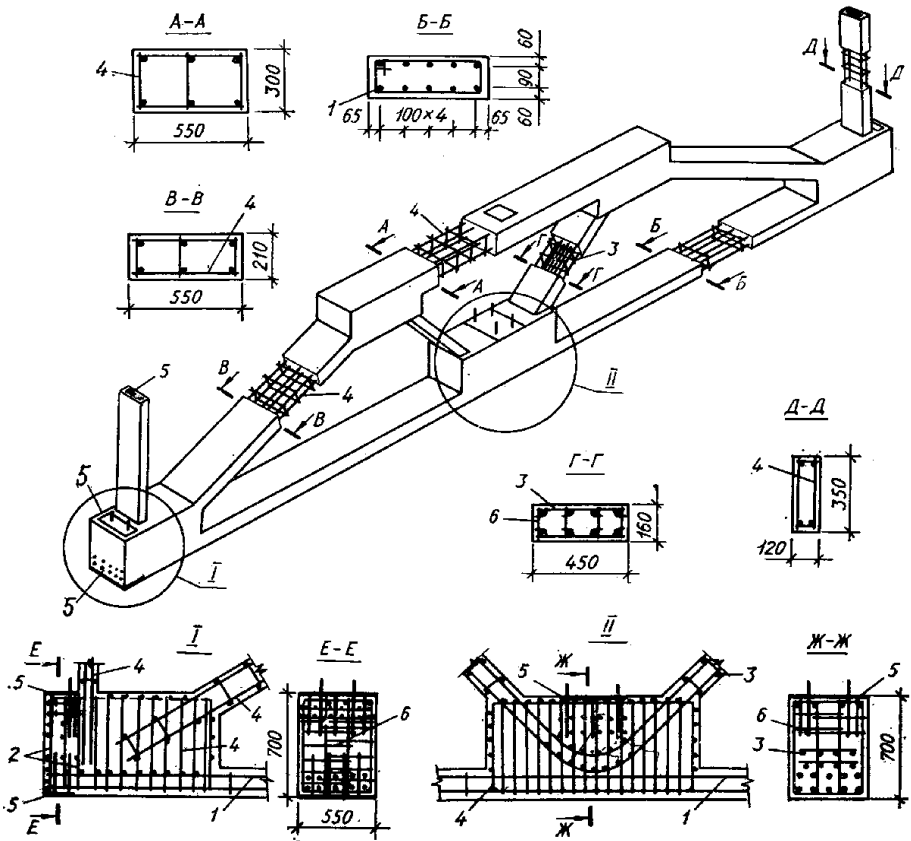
Підкрівляна ферма прольотом 12 м :
